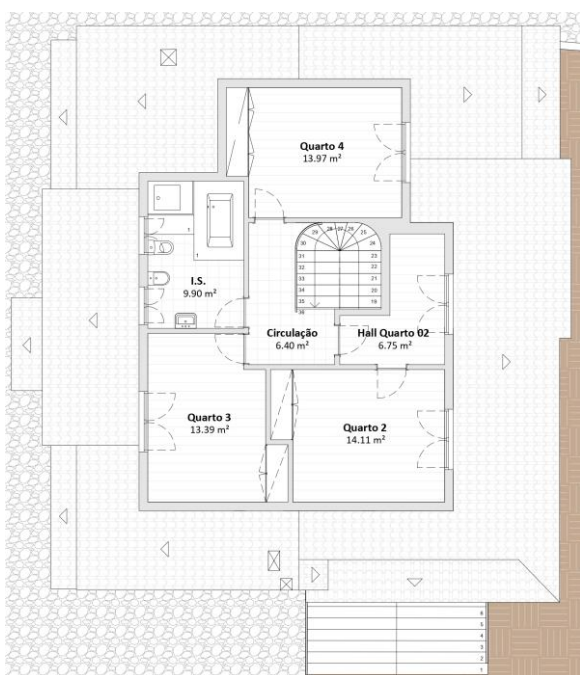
Existente - Planta do piso 1. Fonte: Garq / Desenvolvimento: Autora.
